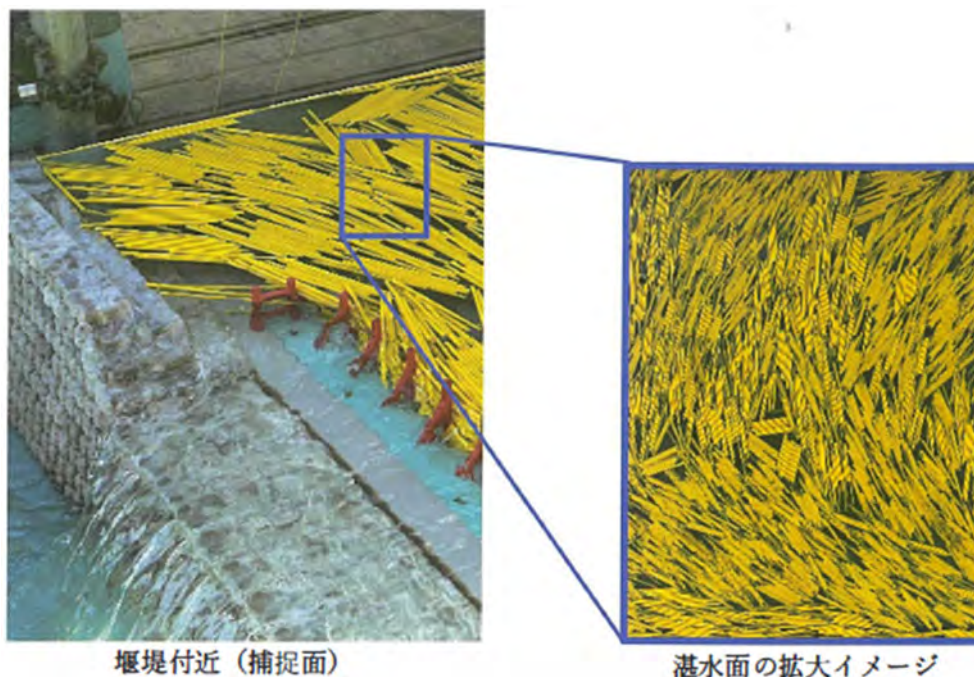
湛水状態の流木捕捉状況³⁾
